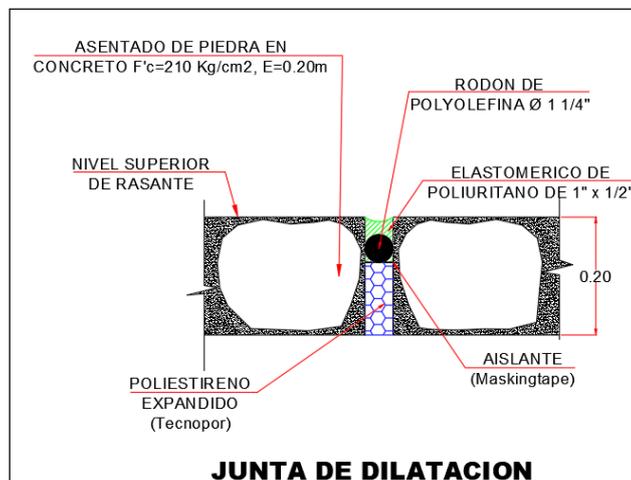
Corrección en los detalles del aliviadero Challwaqocha 2
